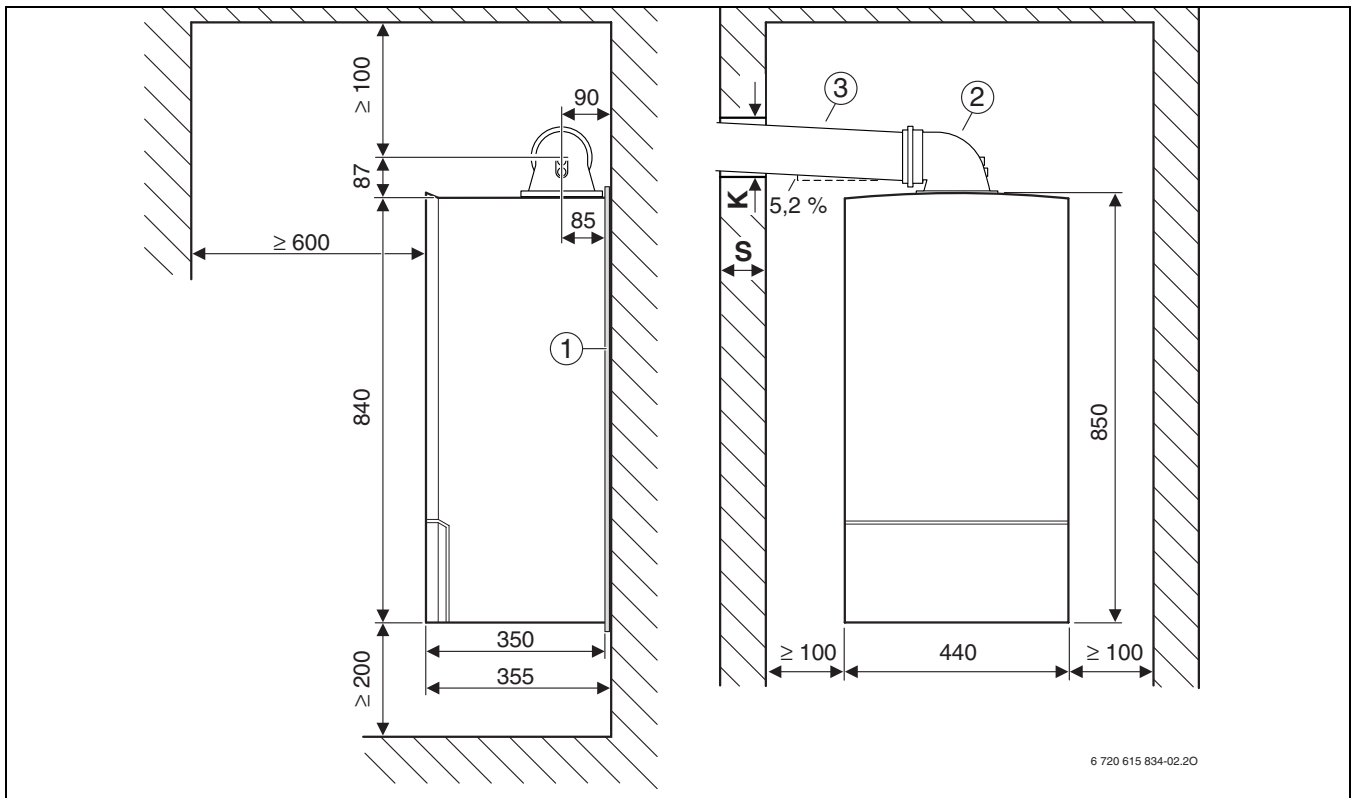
Conduit d'évacuation des fumées Ø 60/100 mm
